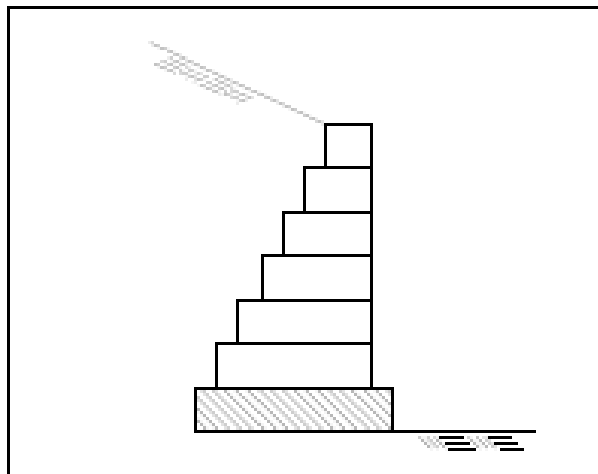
Detalhe dos degraus junto à cota de apoio da estrutura.
